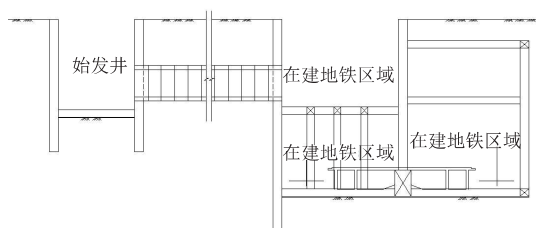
王青公路站Ⅰ号出入口矩形顶管施工立面图
